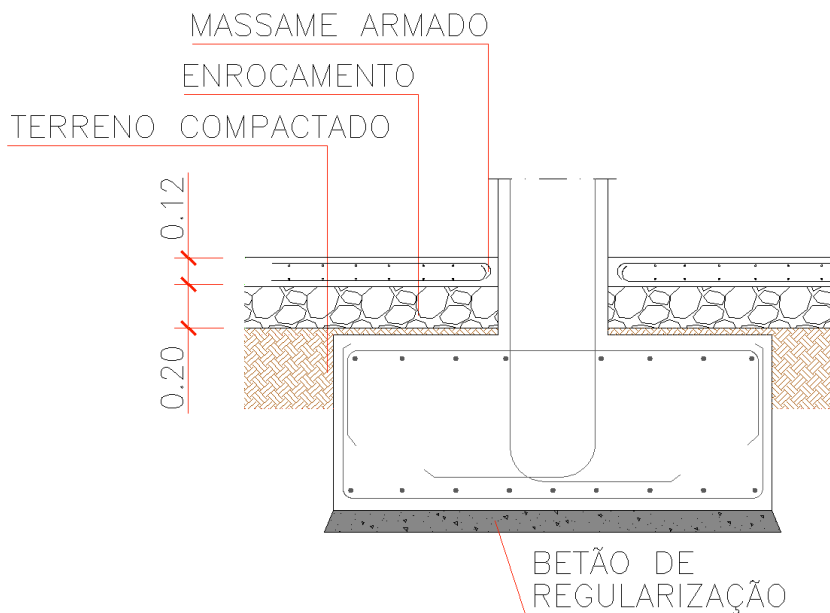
| Sapatas dos pilares e pavimento térreo
